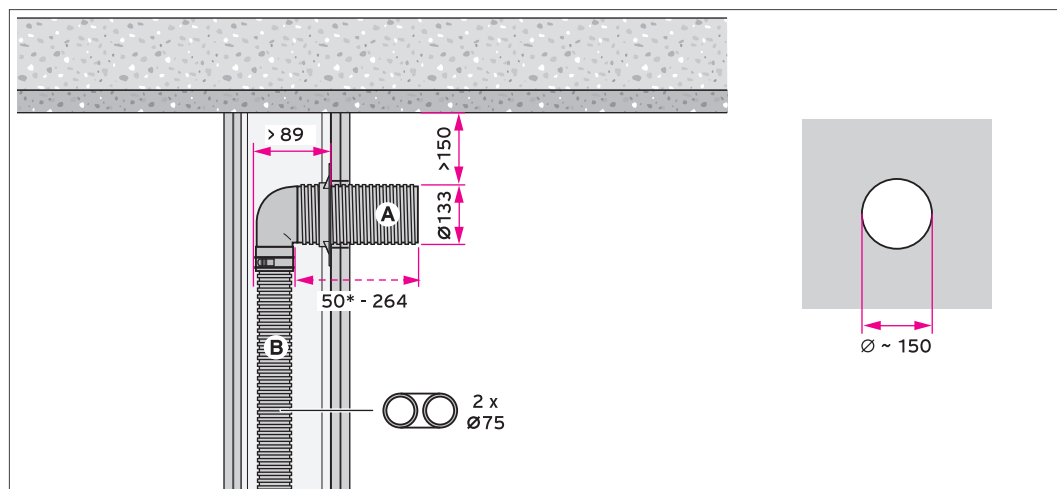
Luftein-/auslass Verlegung in einer Leichtbauwand - Anschluss mit zwei runden Schläuchen
